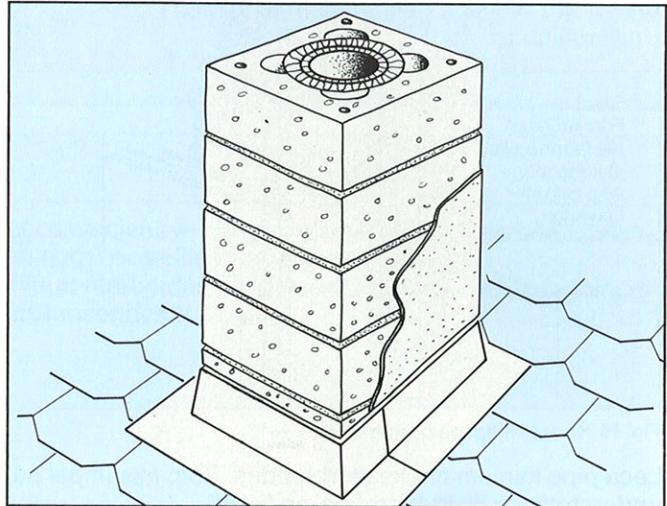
Type PB er tilpasset for flatt takbelegg (papp, shingel m.m.). Anvendes på ettløps pusset pipe.
